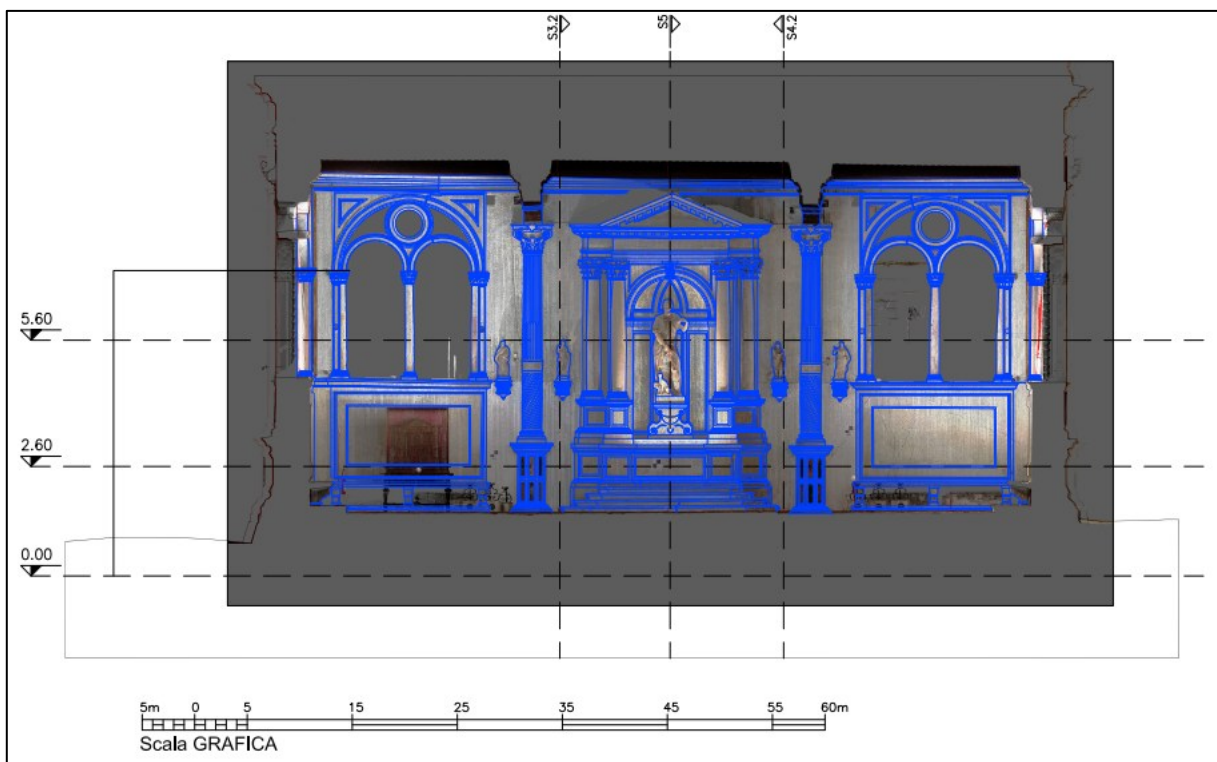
Sezione 1 – Sezione verticale con sovrapposizione dell'orto-proiezione del modello tridimensionale
